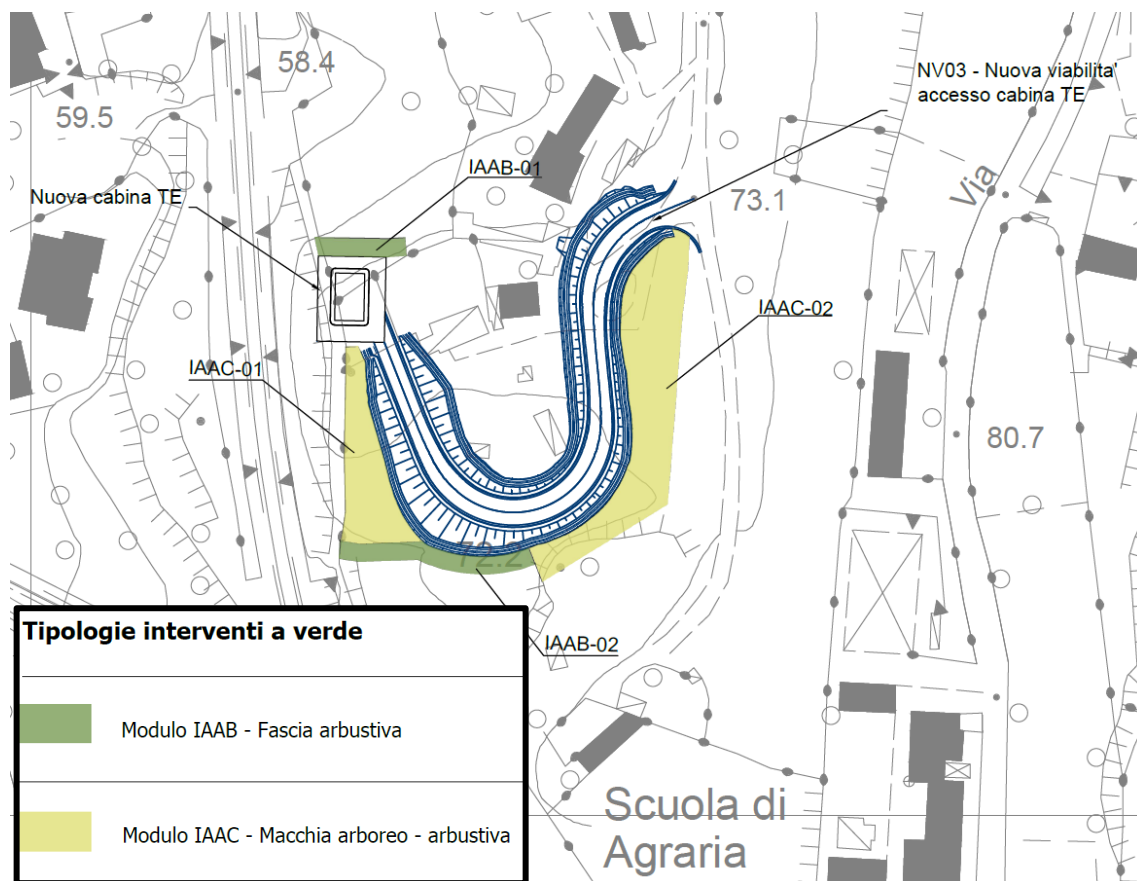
Stralcio Planimetria degli interventi di mitigazione
